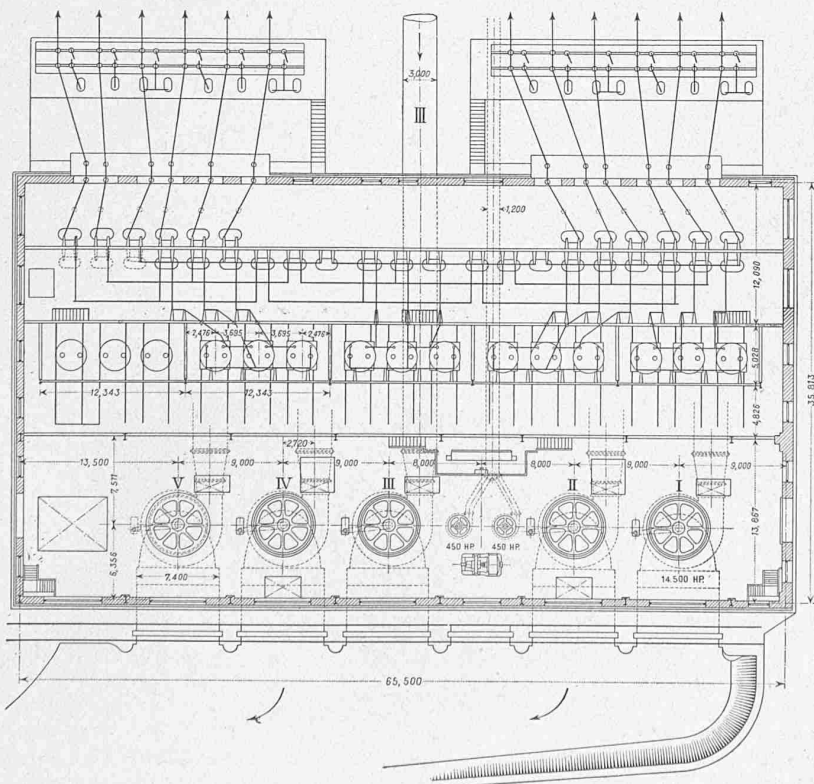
Grundriss des Maschinenhauses. — Masstab 1 : 600 (vergl. Abb. 74).
